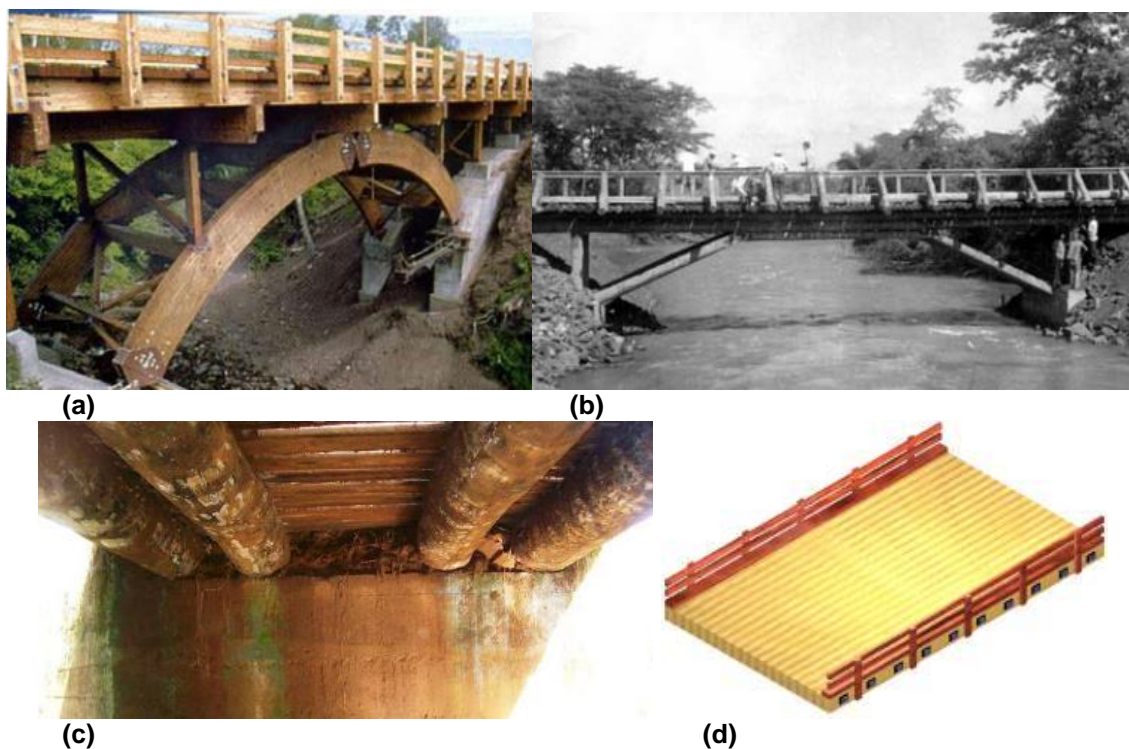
Esquemas estruturais de pontes. (a) Ponte em arco. (b) Ponte em pórtico. (c) Ponte em vigas. (d) Ponte em placa.
